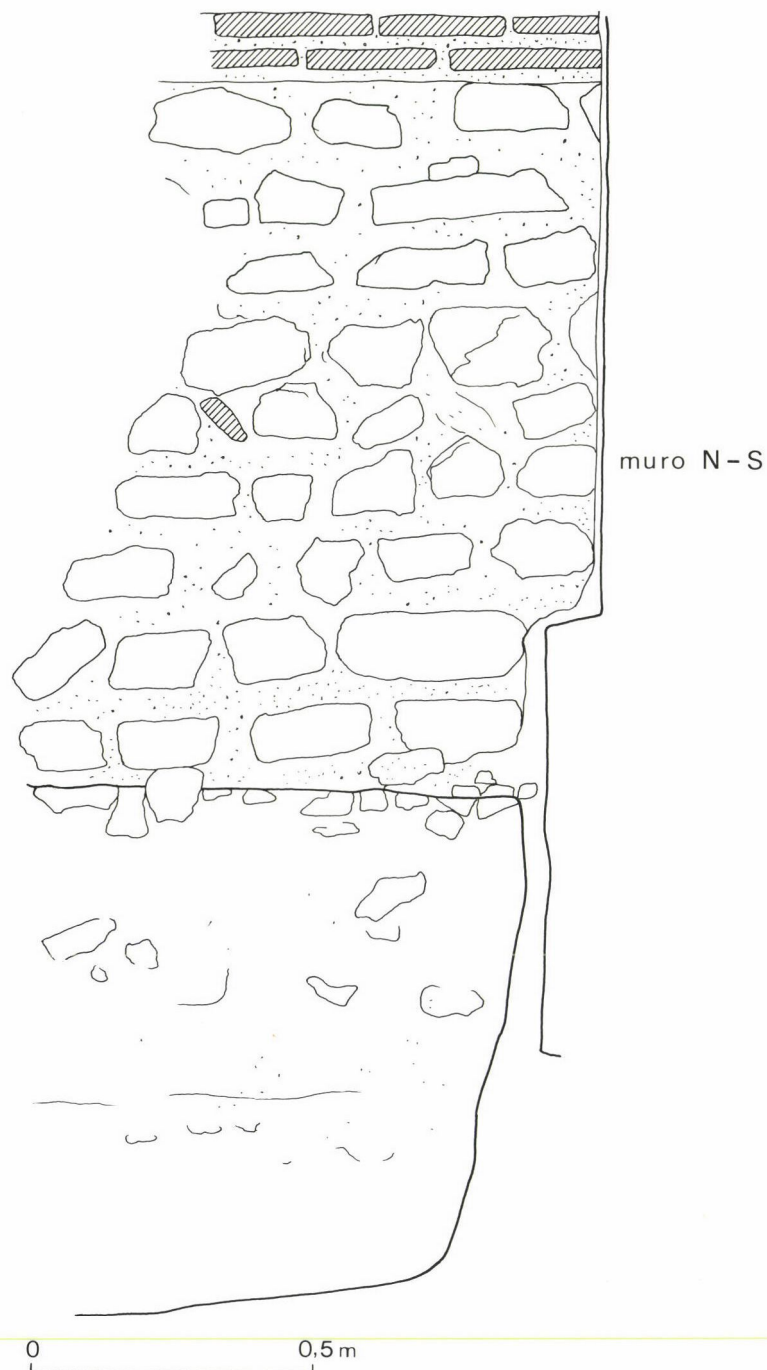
San Potito. Taglio n-1. Il muro E-O (muro perimetrale del cortile) fu aggiunto posteriormente al muro N-S (primo periodo della villa)
